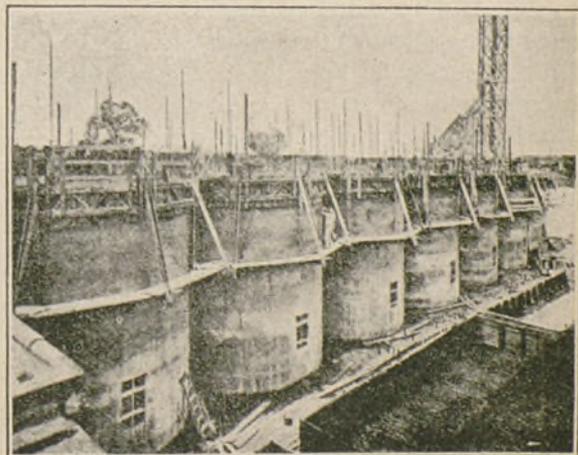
Vista tomada durante la construcción de silos de hormigón armado, con formas móviles.
